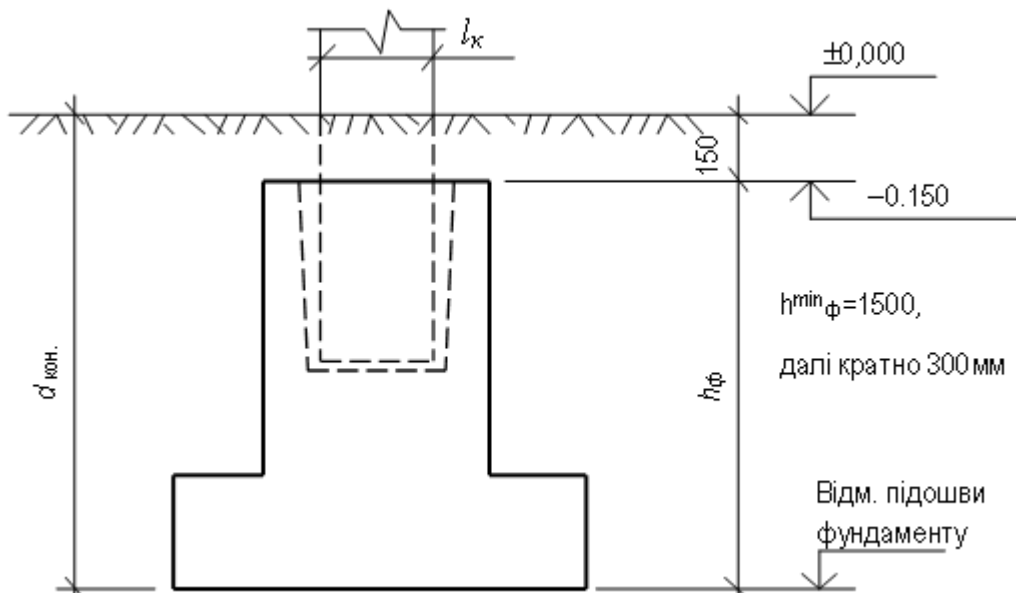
Попереднє конструювання окремого (стовпчастого), монолітного фундаменту під збірну залізобетонну колону (без підвалу)
